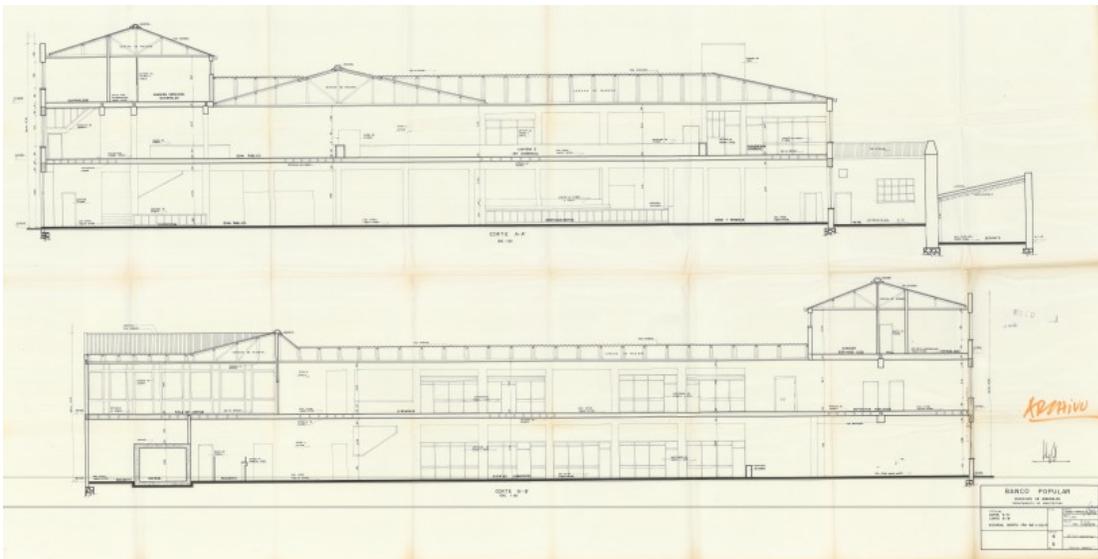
Fuente: Planimetría en archivo del IDPC correspondiente al inmueble ubicado en la carrera 8 11 73/75/77
